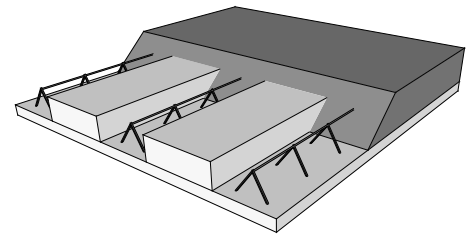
Konstruktionschema Elementplatte mit Verdrängungskörpern
